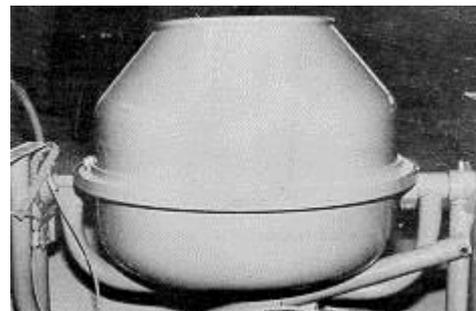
Protección de la corona y engranaje de rotación de la hormiguera
